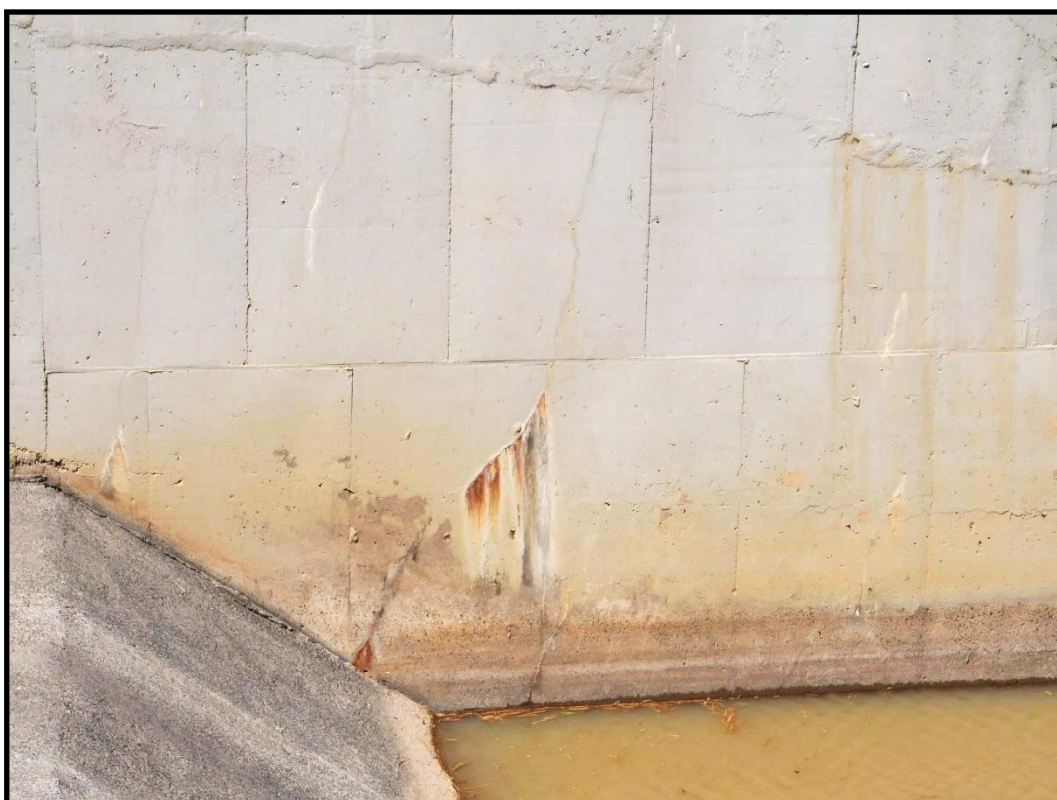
Detalhe da fissura no muro lateral esquerdo.
